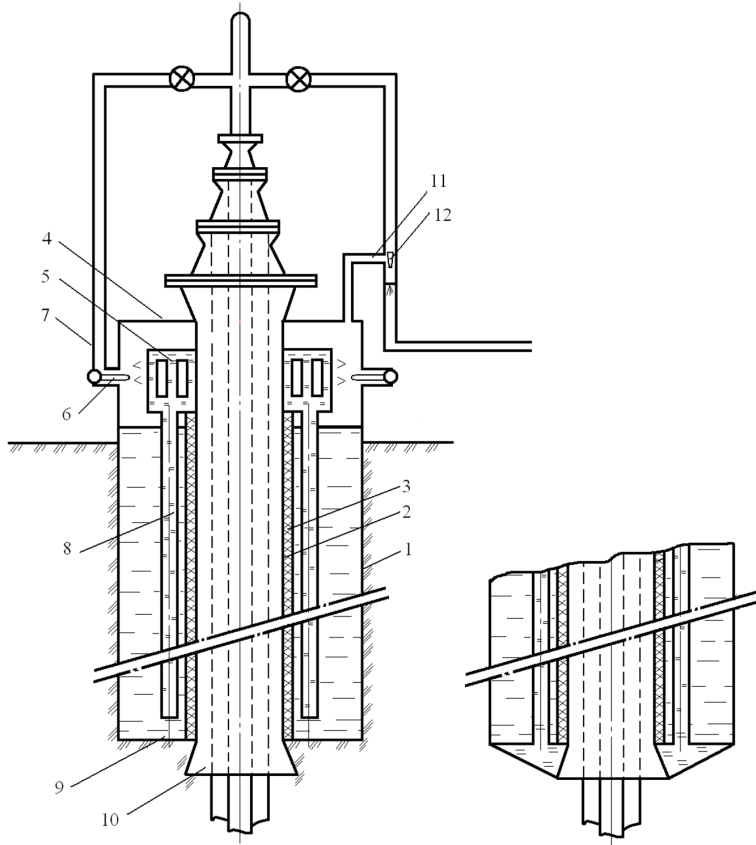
Рефрижераторное шахтовое направление: 1 – корпус; 2 – внутренняя труба; 3 – тепловая изоляция; 4 – крышка; 5 – теплообменник; 6 – генератор холода; 7 – наружный газопровод; 8 – циркуляционные трубы; 9 – нижнее торцевое кольцо; 10 – раструб; 11 – отвод отработанного газа; 12 – струйное устройство
